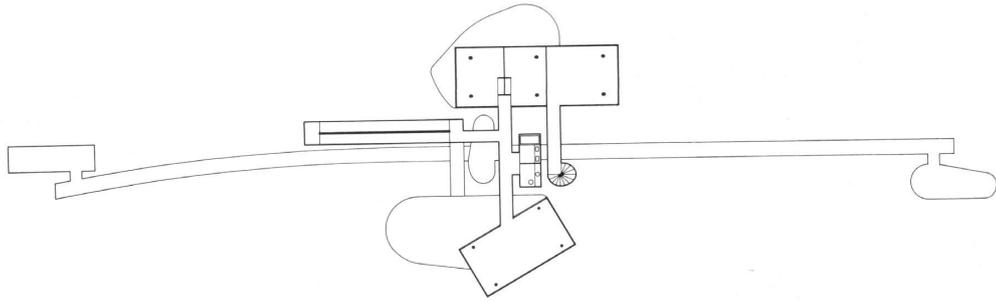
John Frederick Colamarino, *House* (1968-1969). Planta baixa pav. superior.
